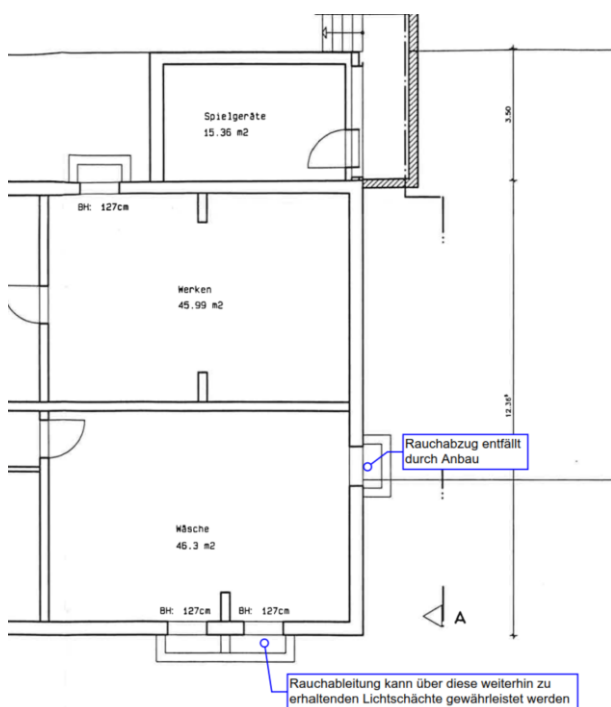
Ausschnitt Grundriss Kellergeschoss „Anbau Kita Prötzel“, Ingenieurbüro für Bauplanung, Jörg Stiller [7]
